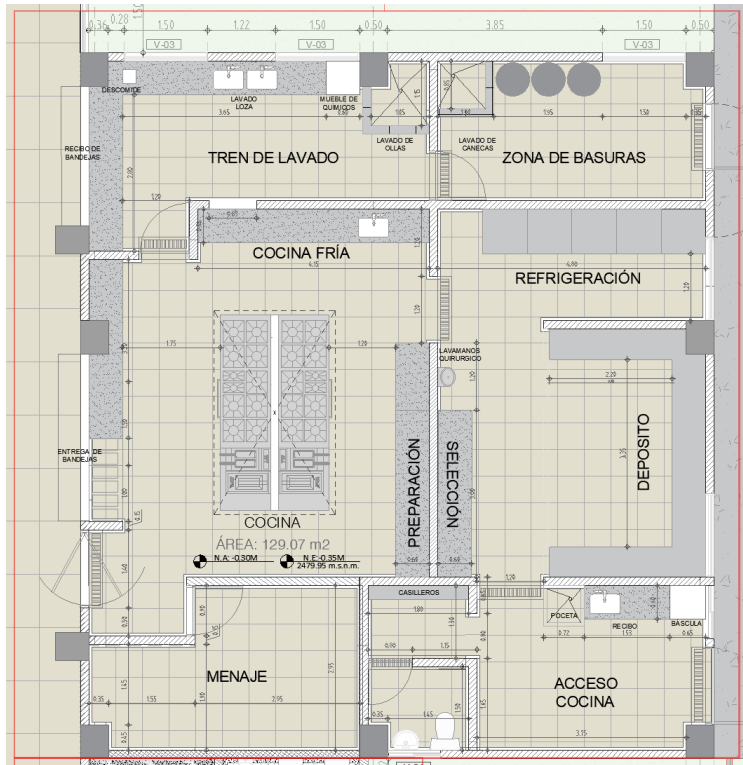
Localización de columnas y zona cocina I.E POLITÉCNICO ALVARO
